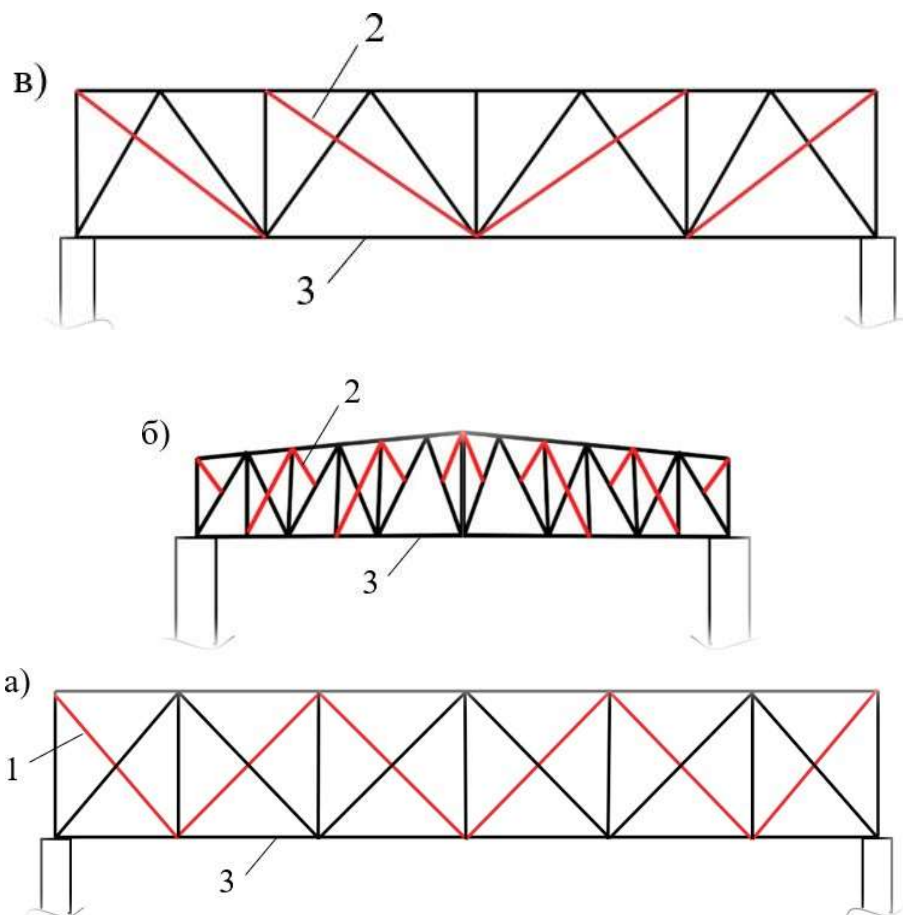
а) ферма с дополнительной решёткой; б, в) фермы с перекрёстной решёткой; 1 — вторая решётка, 2 — перекрёстная решётка, 3 — усиливаемая ферма
